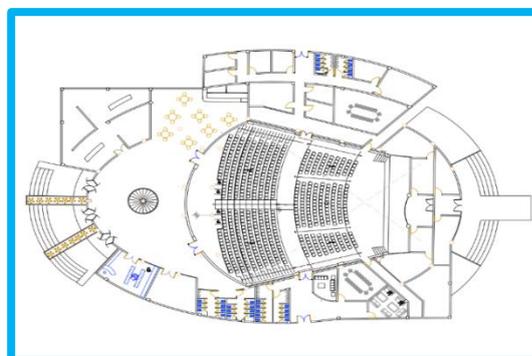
Plan de rez de chaussé, Source : Auteur, 2022.
